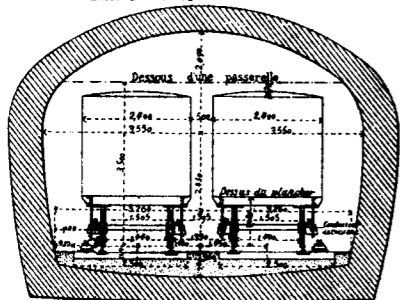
Type de station à plancher métallique. Coupe transversale.
